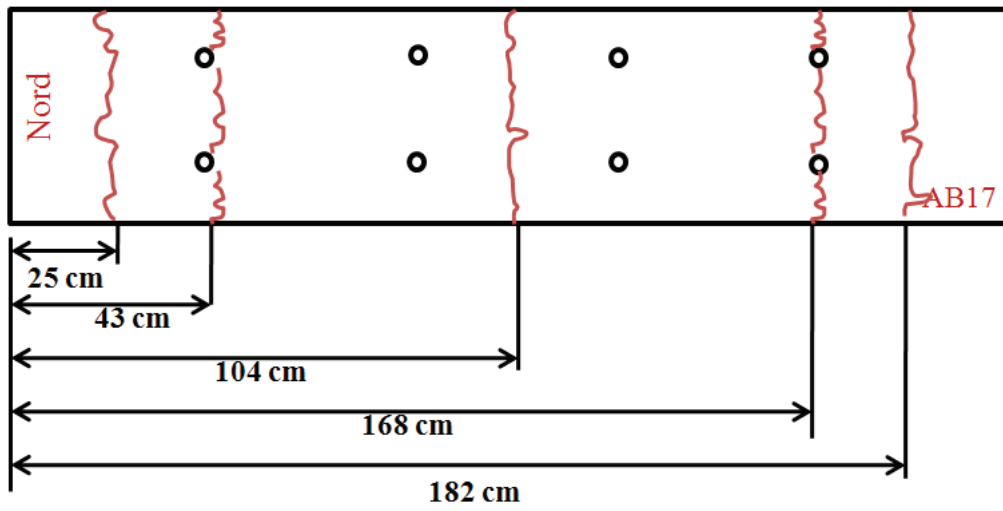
Relevé des fissures sur la poutre AB17
